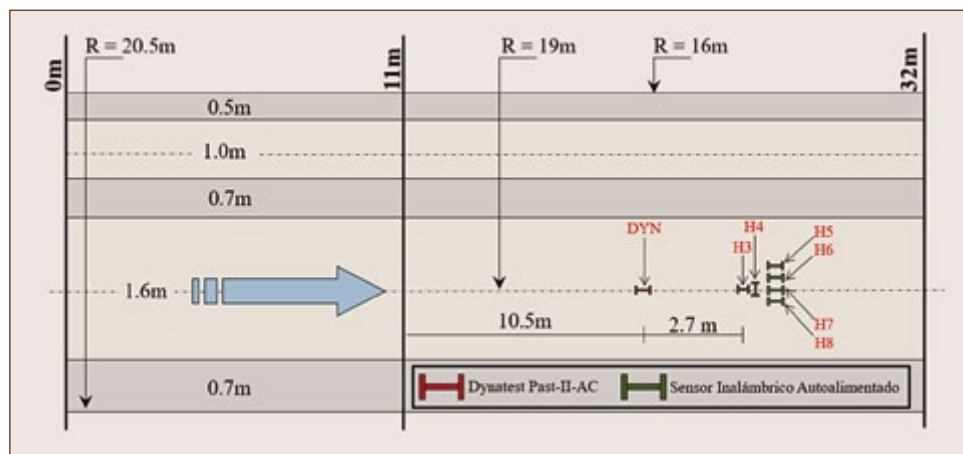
Distribución de sensores dentro de la estructura de pavimento.
